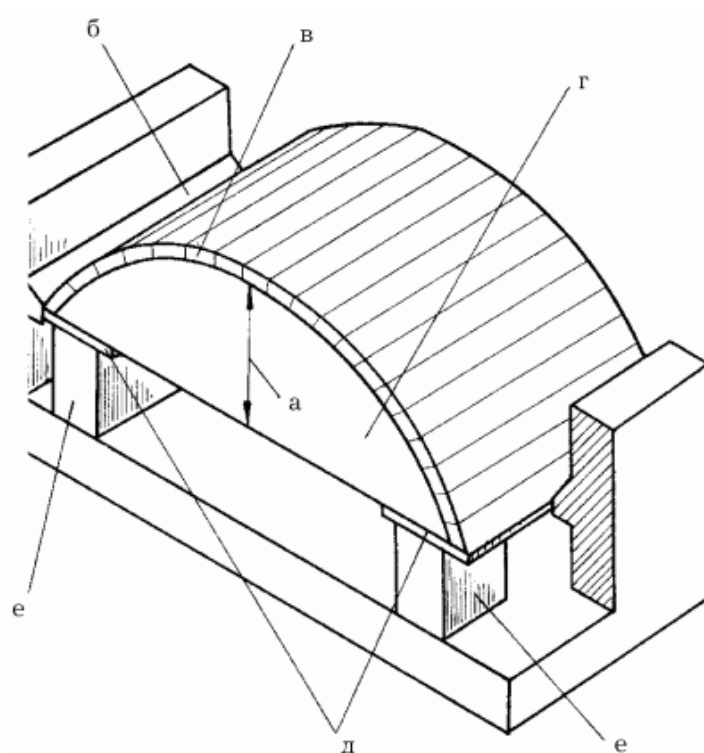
Устройство опалубки для арочного перекрытия: а – подъем свода; б – пята свода; в – опалубка; г – кружало; д – подкружальные доски; е – доски.
